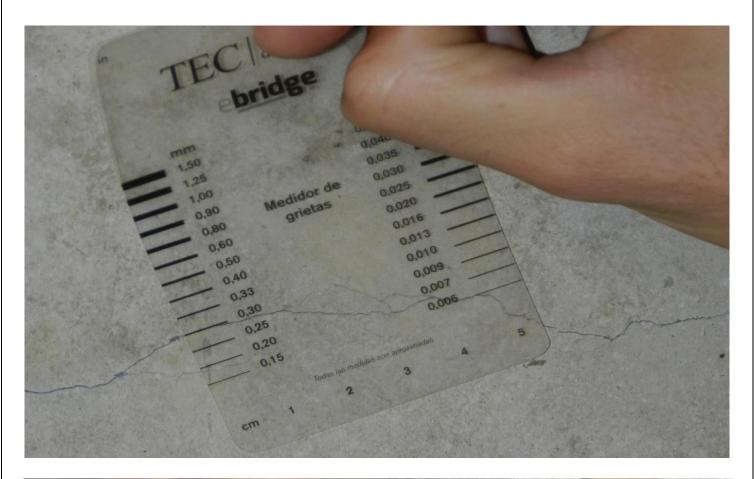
Grietas en una dirección. Fuente: PEEP (2018).
